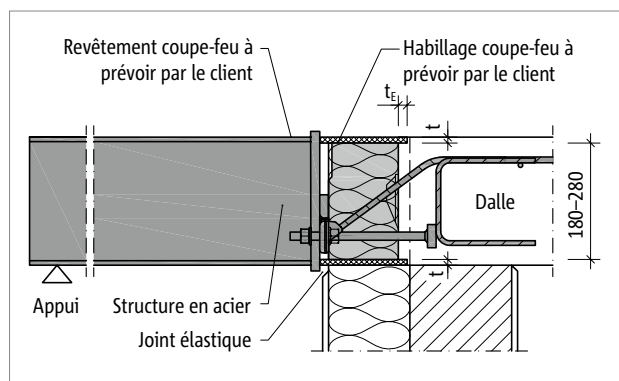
Schöck Isokorb® XT type SQ : habillage anti-feu prévu par le client pour l'Isokorb®, structure en acier munie d'un revêtement de protection incendie ; vue en coupe
